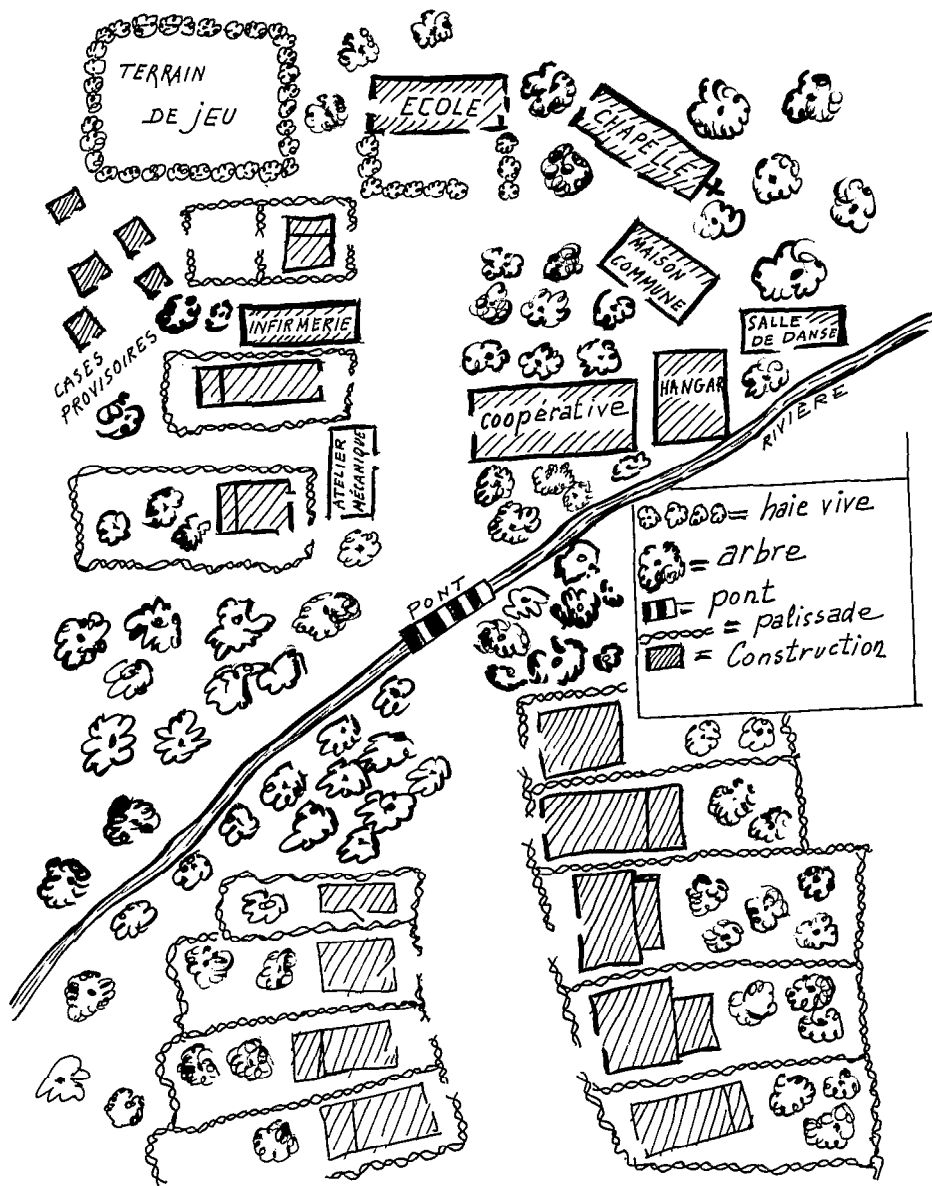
Plan d'un village pionnier conçu par de jeunes ruraux.
